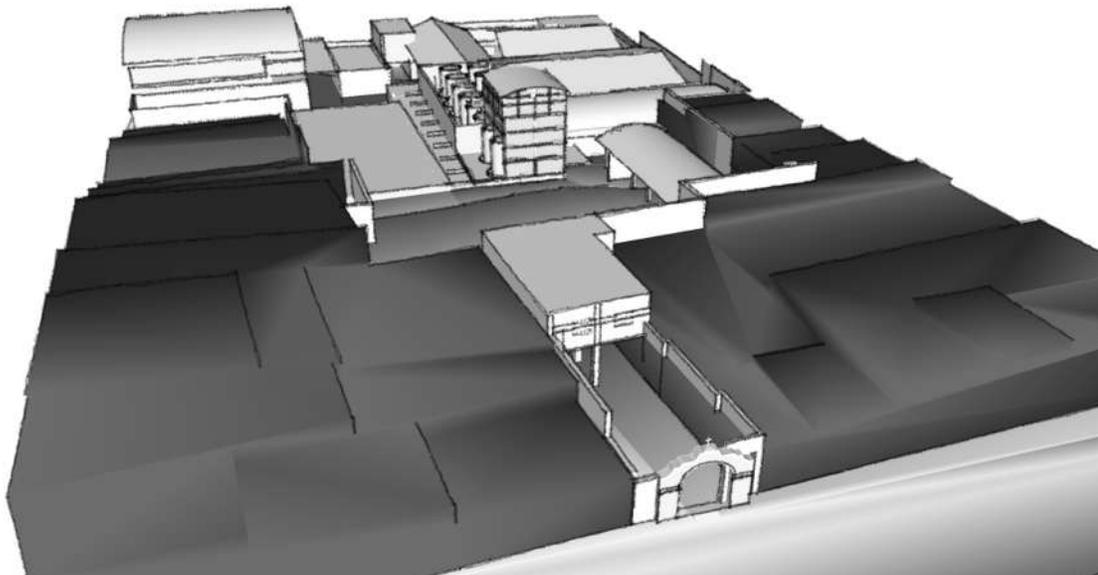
Reconstrucción volumétrica. Vista sur.
